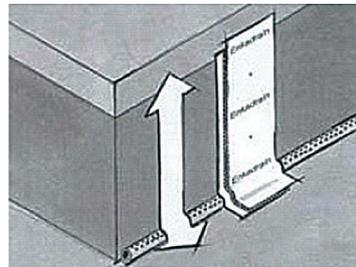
Заведение полотен Enkadrain® на стену фундамента
